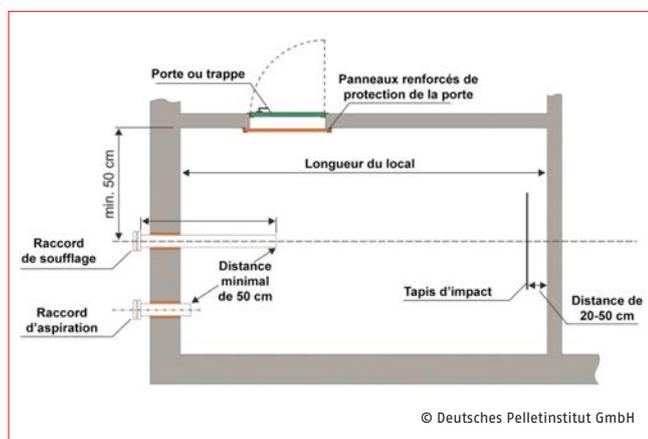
Plan d'un local de stockage de pellets (ventilation par système de remplissage)
